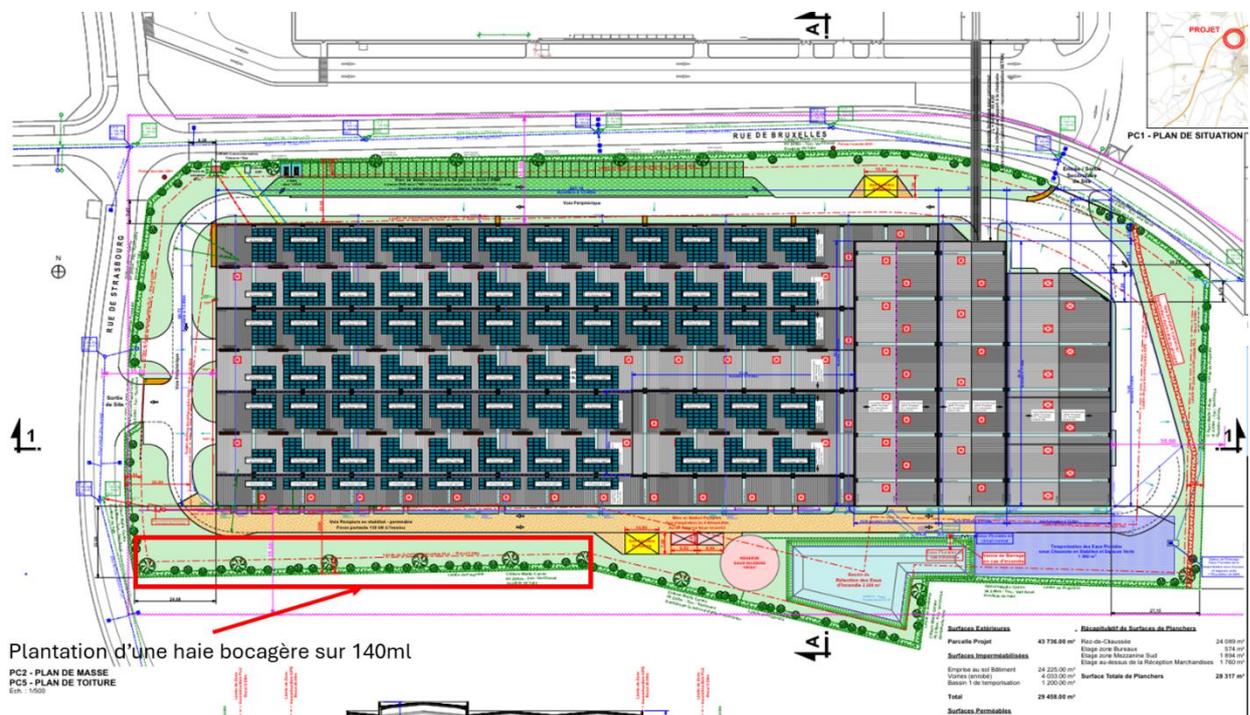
Localisation de la plantation de la haie bocagère (source : plan masse, janvier 2025)
